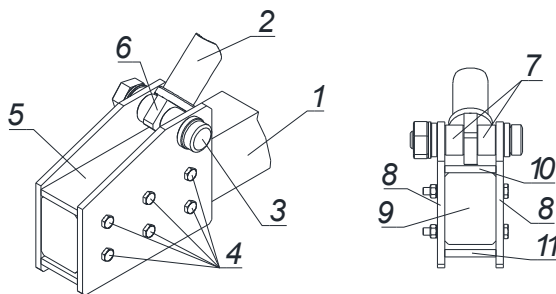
Узел примыкания арки к балке. 1- балка (затяжка); 2- арка; 3- палец; 4- болты; 5- башмак; 6- серьга; 7- втулки; 8- боковые щеки; 9- торец башмака; 10- верхняя планка; 11- нижняя планка.
